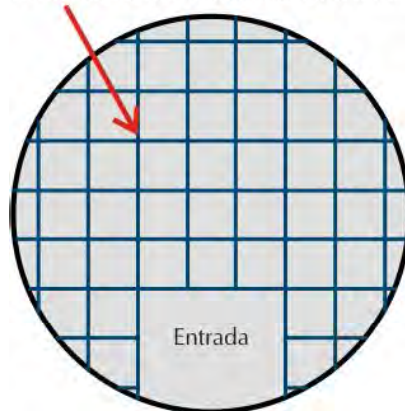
Vista en planta de la estructura de fierro que dará origen a la cubierta de la cisterna.
